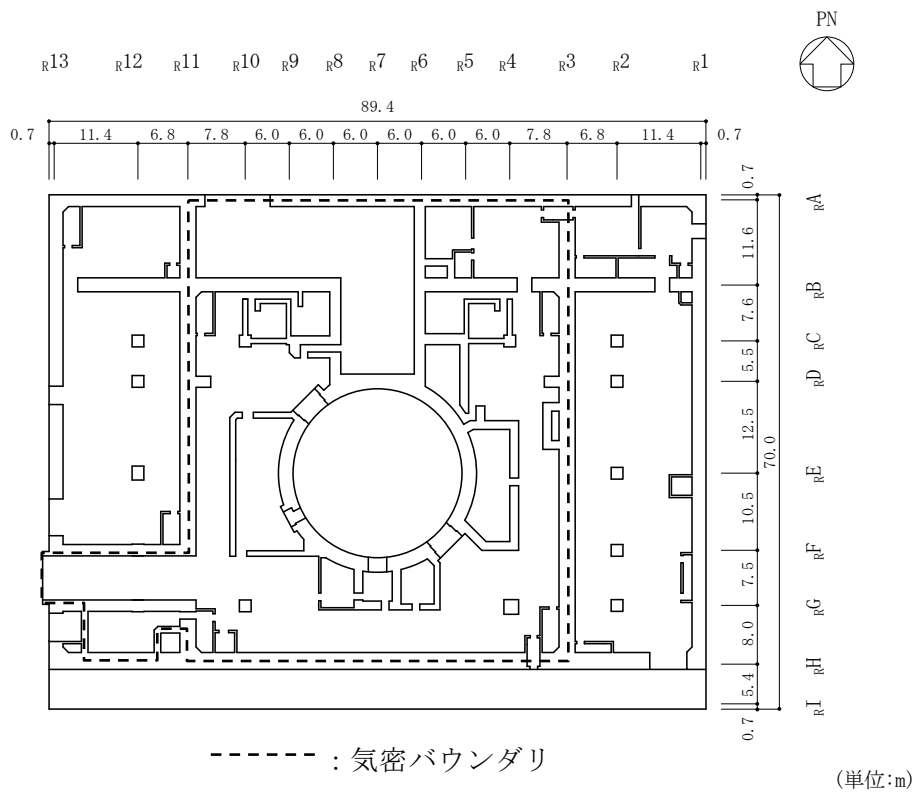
(3) 原子炉建物原子炉棟（二次格納施設）の概略平面図（EL 15.3m）
